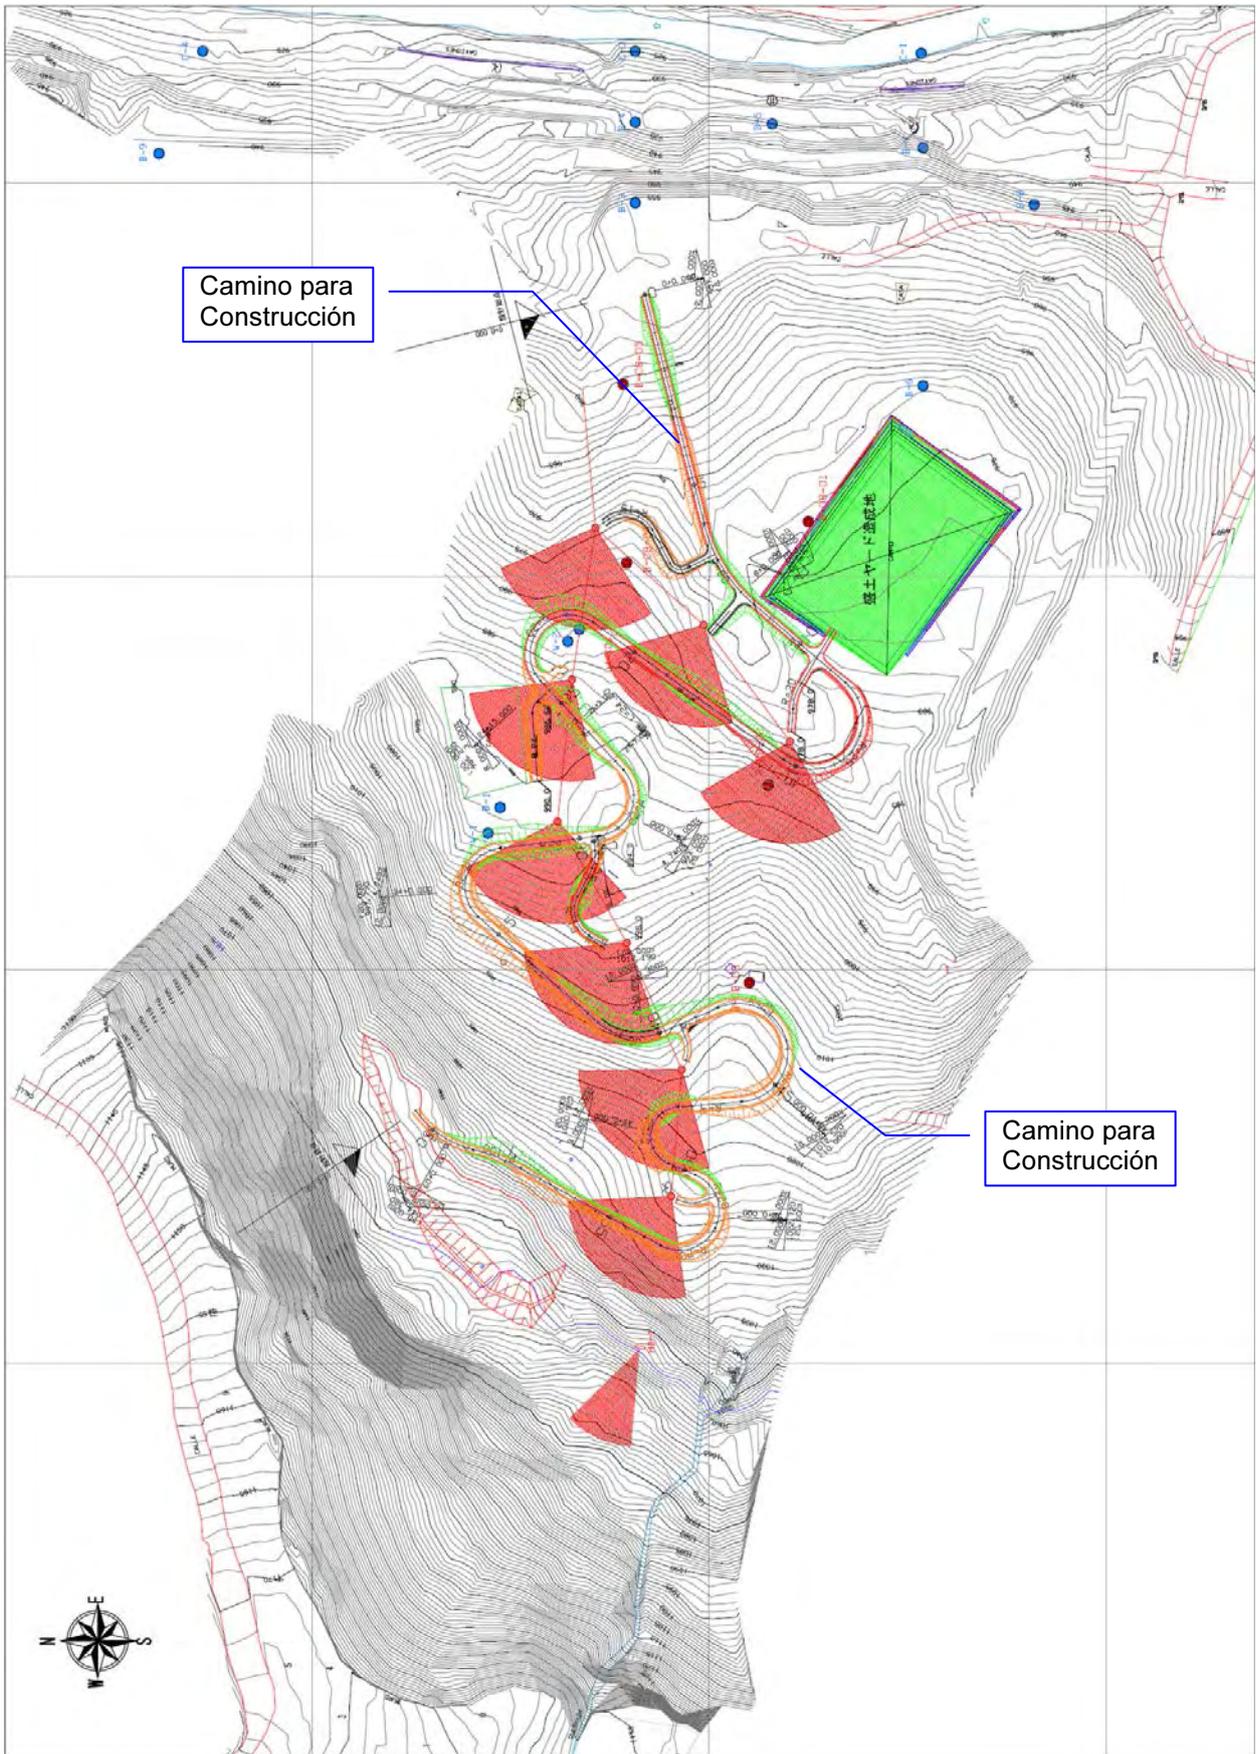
Vista en Planta del Camino para la Construcción (El Berrinche)
